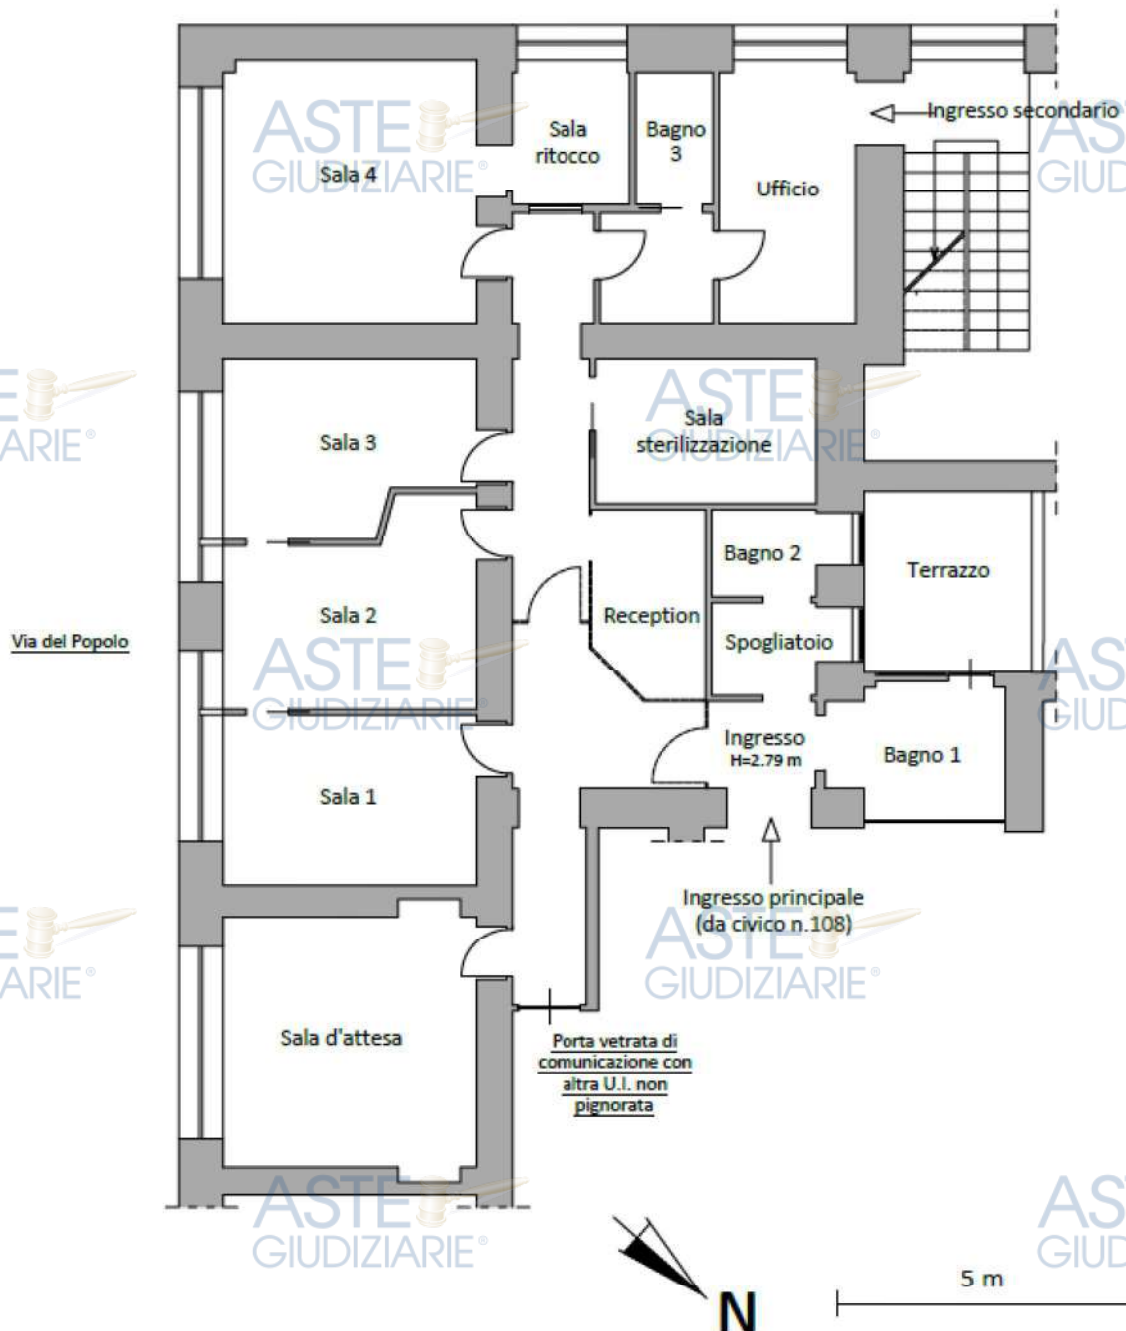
Planimetria dello stato reale dei luoghi - Studio Privato Piano terra
